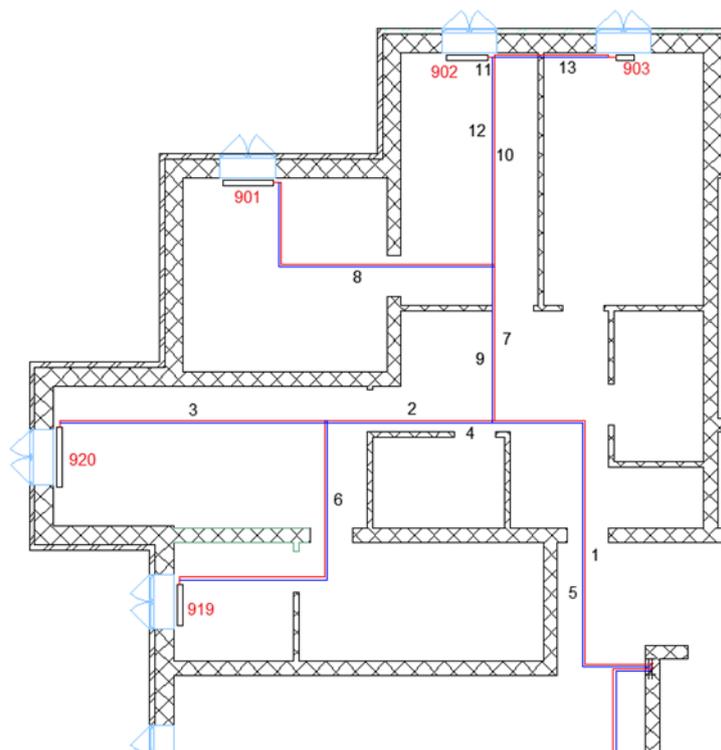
План квартиры последнего этажа с петлевой смешанной разводкой системы отопления
